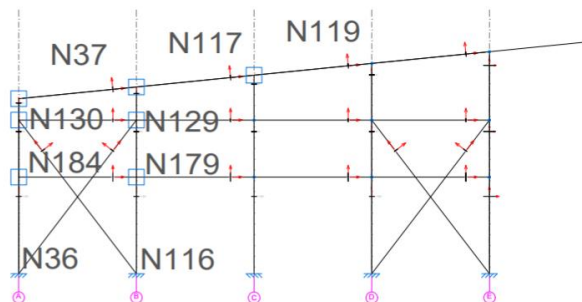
Pórtico de fachada de nave secundaria con numeración de nudos
